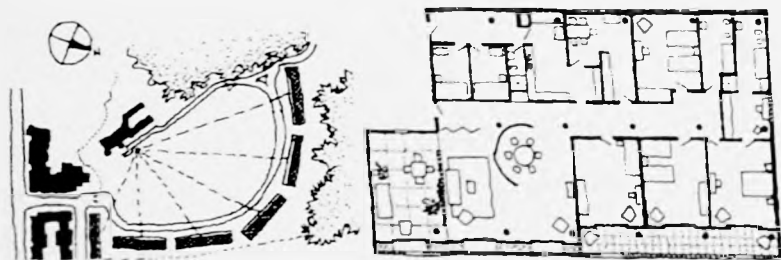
e 440 Implantação e planta apartamento tipo do edifício Bristol, Parque Guinle.
